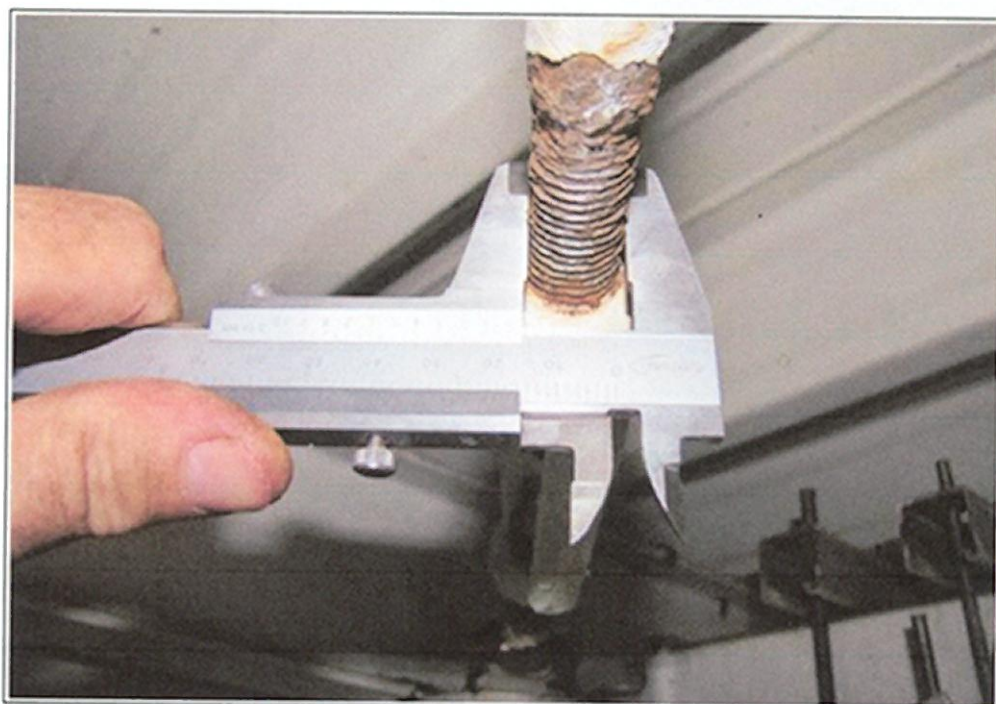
Hala (od B18) – Korozja gwintu ściagu prętowego, typowy przykład z strefy 6d3.2 i 6d3.3
